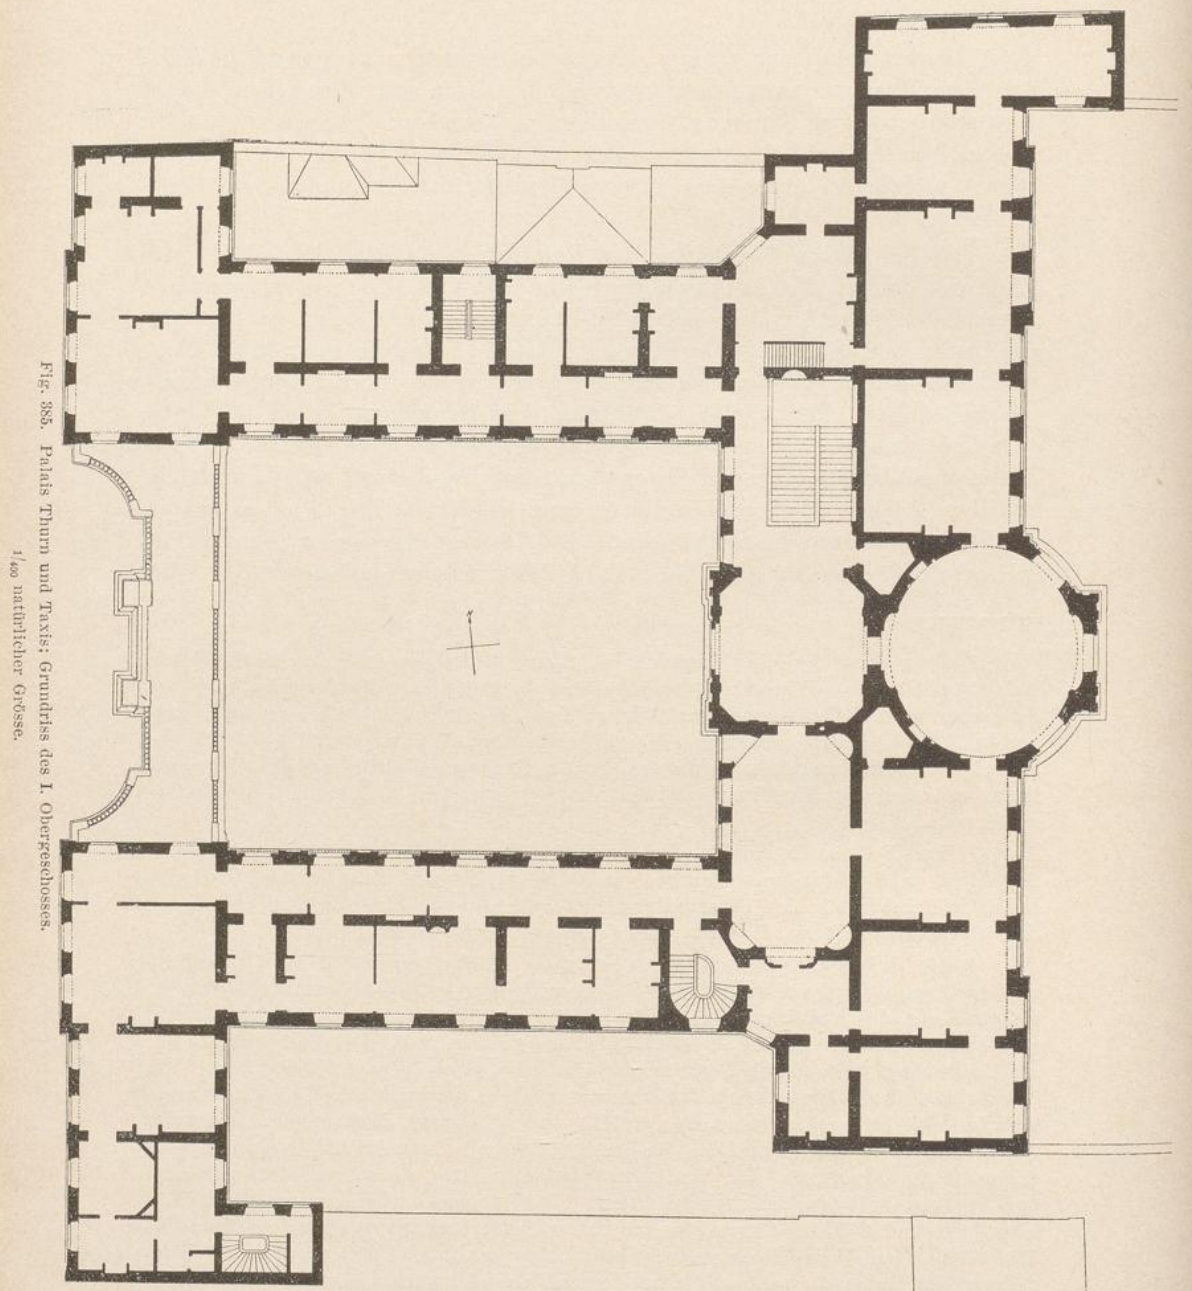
Palais Thurn und Taxis; Grundriss des 1. Obergeschosses.
